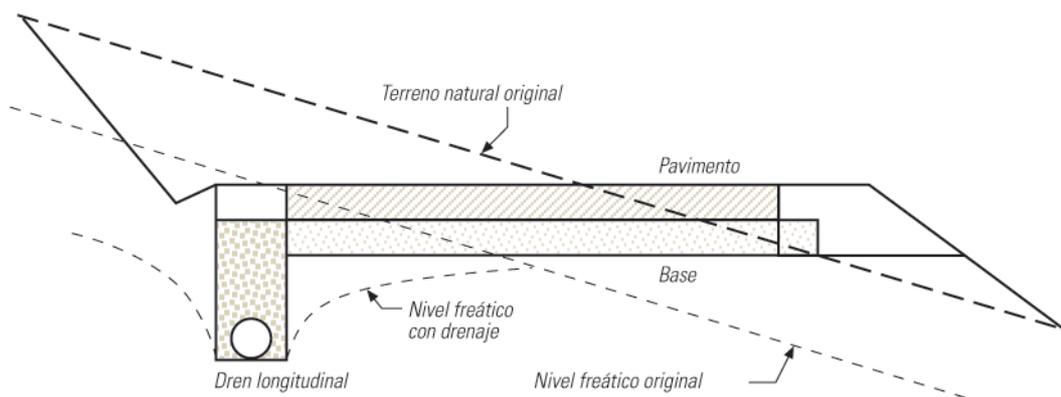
Dren longitudinal en secciones a media ladera para rebajar el nivel freático
